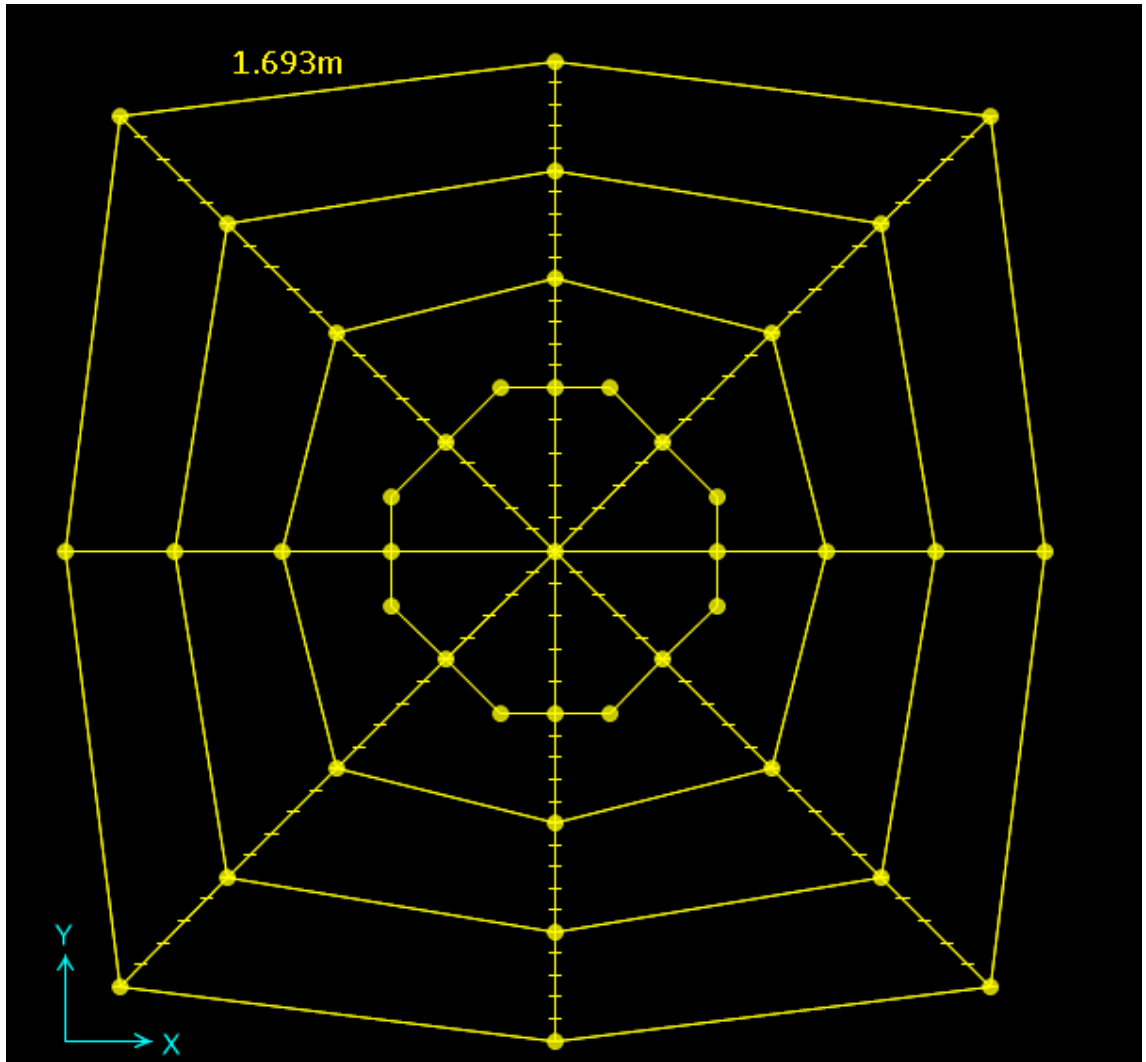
Distancia entre vigas para la distribución de carga de nieve.
